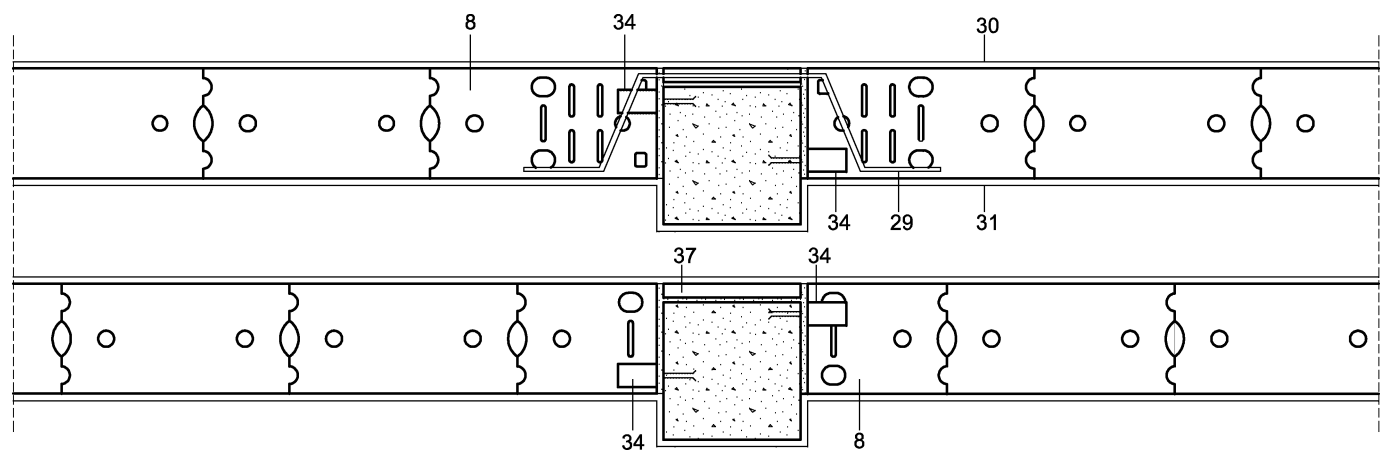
Encuentro con pilar en tramo recto. Hiladas par e impar.
